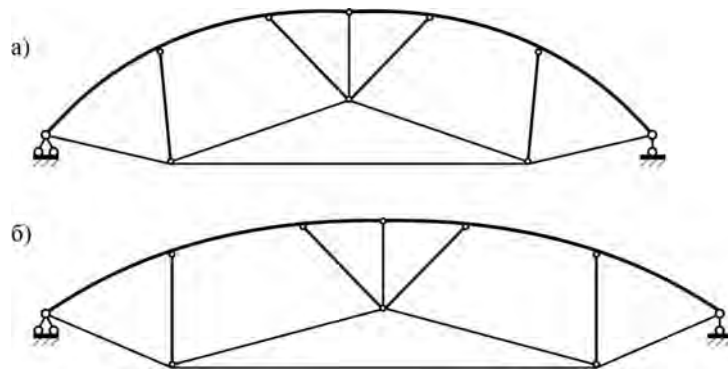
Деформированная схема конструкции покрытия: а — под воздействием нагрузки 3 (см. рис. 5); б — без внешней нагрузки
